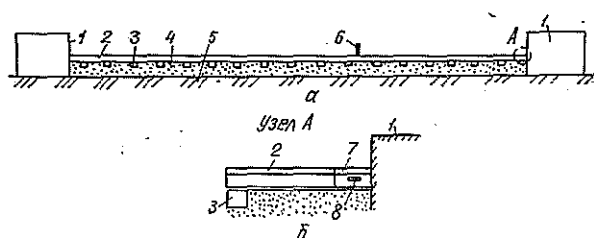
Расчетные схемы: а — схема стенда; б — узел установки вкладыша; 1 — упоры; 2 — рельс; 3 — шпалы; 4 — балласт; 5 — земляное полотно; 6 — термометр; 7 — вкладыш; 8 — тензорезистор
